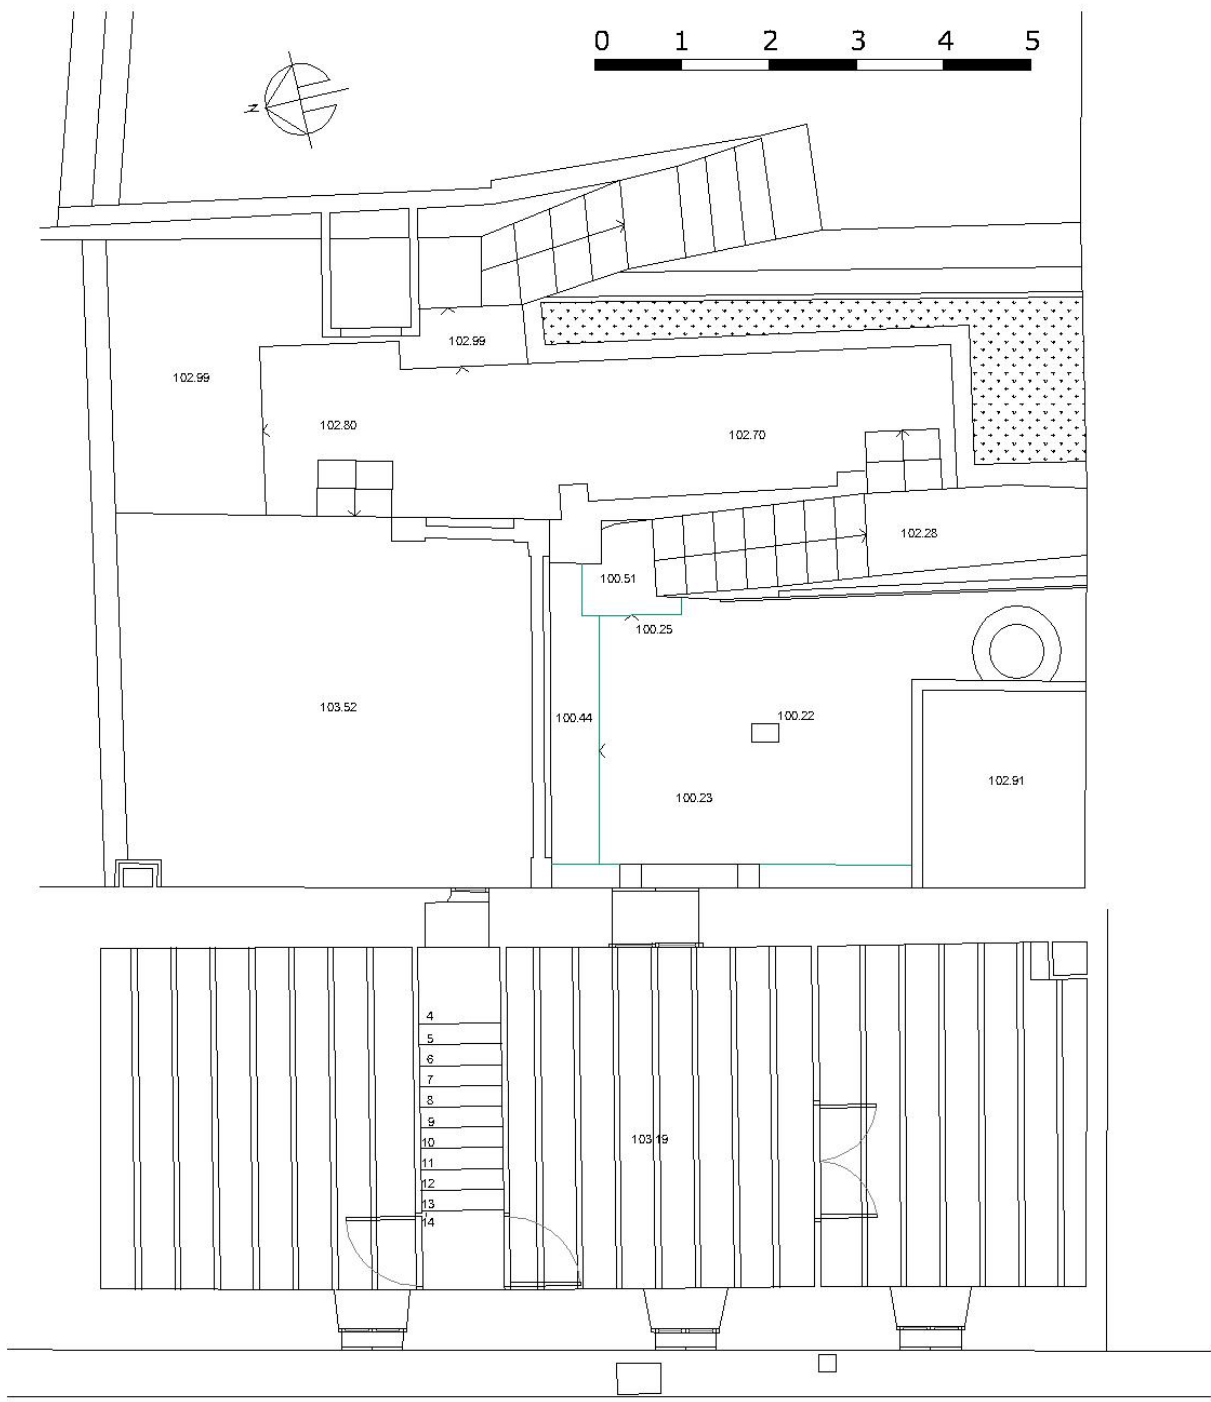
Estado actual de la vivienda sita en calle Llum, 9. Planta primera
